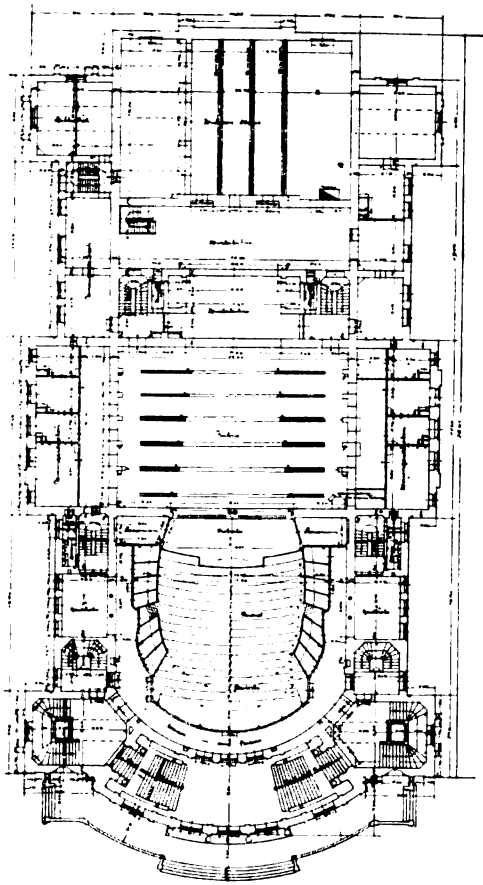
Grundriss des Parterres. 1:740.
